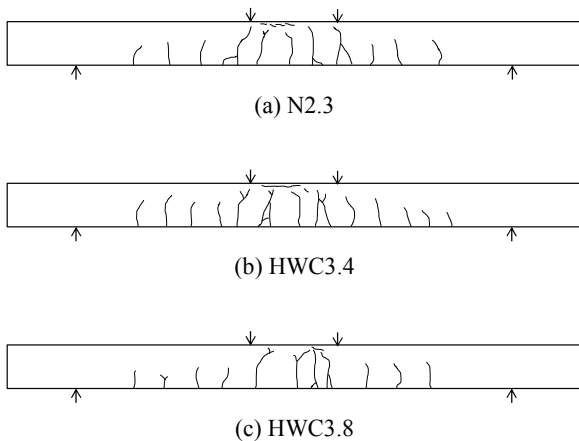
ひび割れ図 (曲げ破壊型)
